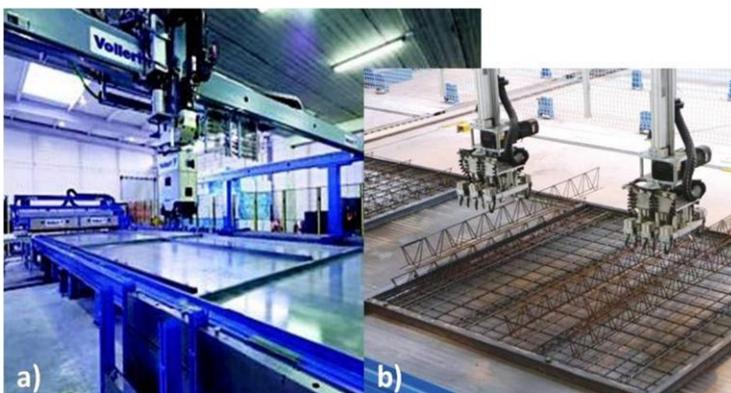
a) Trazado del contorno y posicionamiento de las guialderas para la conformación geométrica de los futuros componentes prefabricados. b) Procedimiento de colocación de las armaduras en los moldes. Fuente: <https://www.youtube.com/VollertAnlagenbau>
